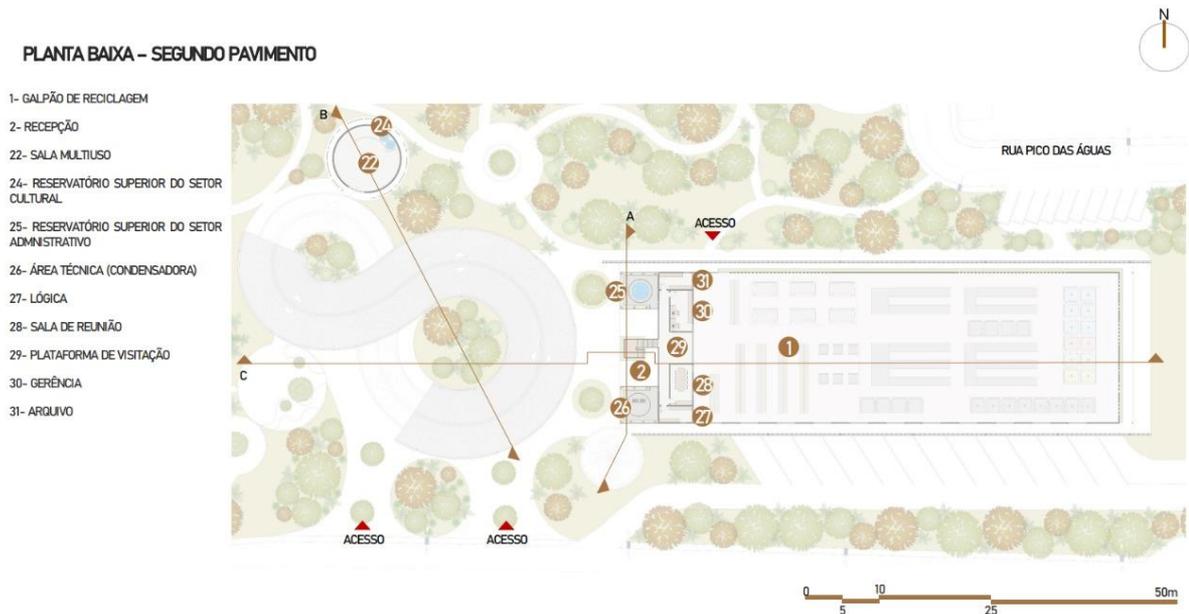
Planta Segundo Pavimento FONTE: Acervo da Autora
